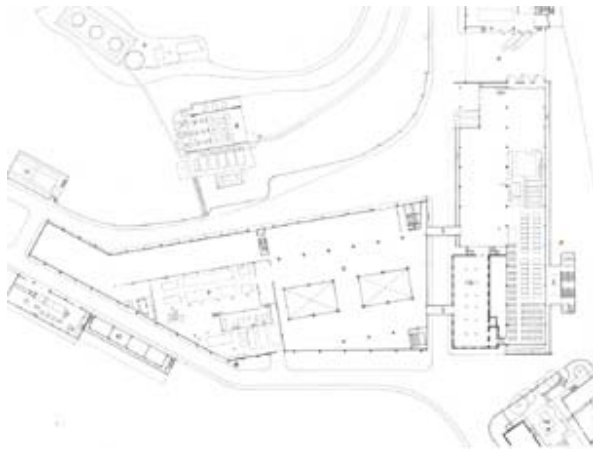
Hering Matriz: planta do conjunto da costura e beneficiamento.
